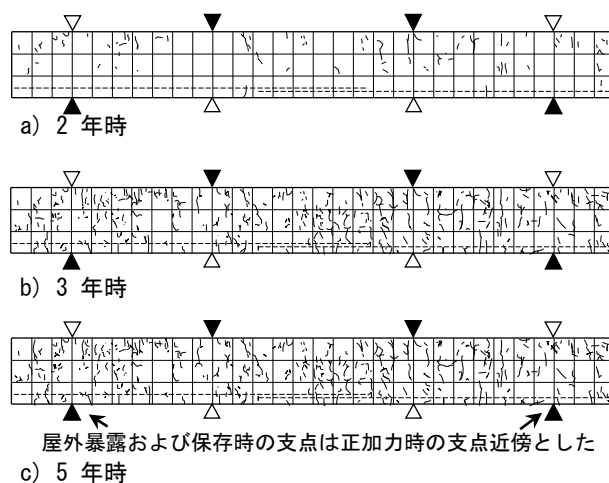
乾燥収縮ひび割れの発生状況 (RM75S5E)
